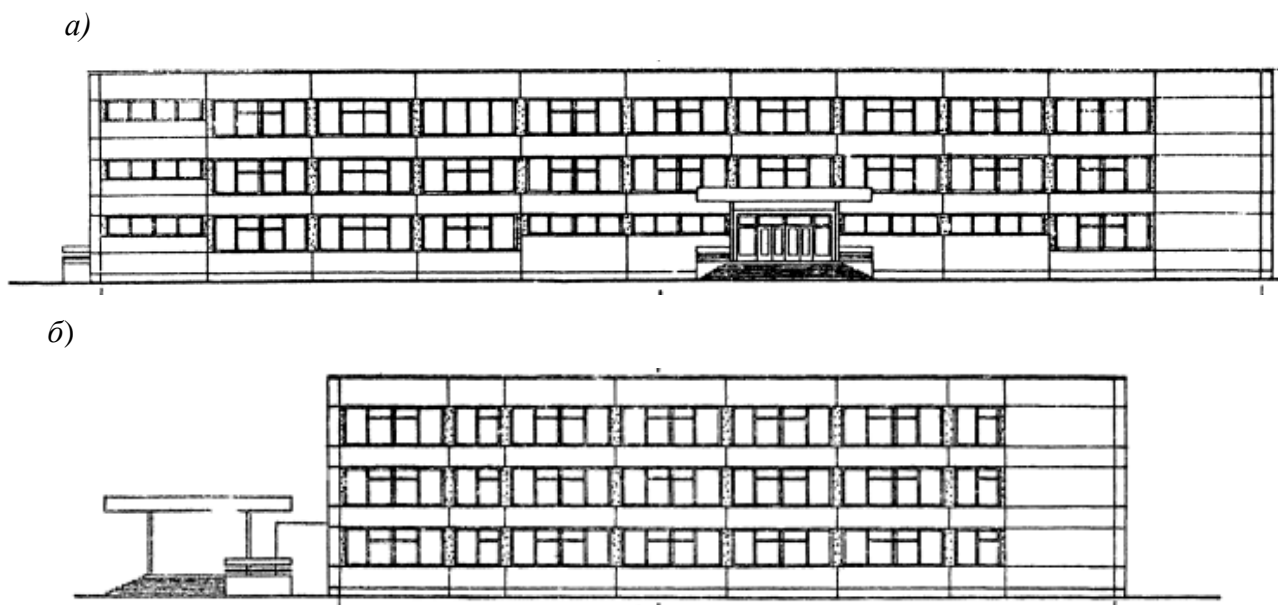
Фасады здания школы на 1176 учащихся в г. Белгород (типовой проект 222-1-193/75): а – фасад в осях 1-14; б – фасад в осях А-М
